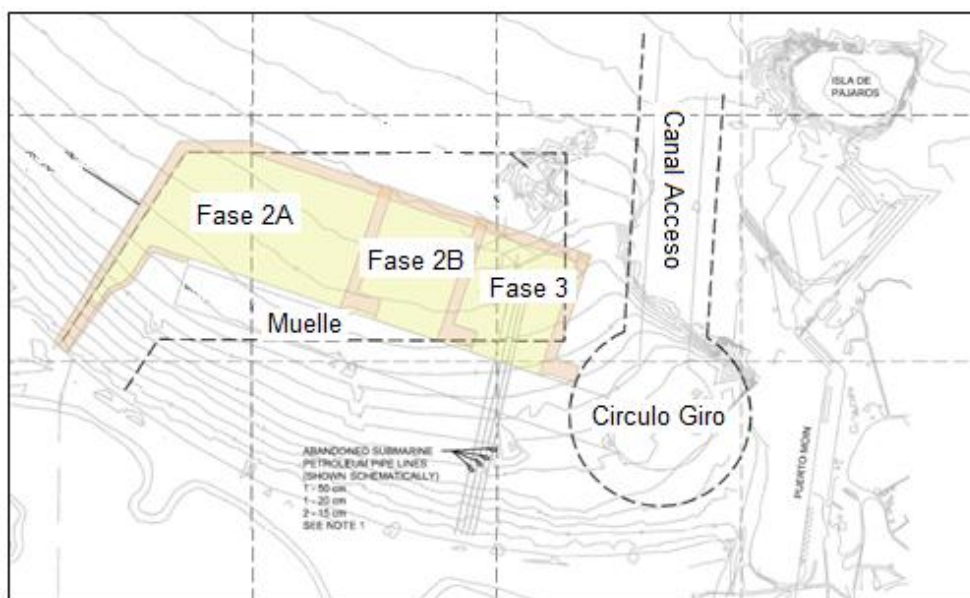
Vista en planta general del proyecto de reclamación. Fuente: Modificado de APM Terminals (2016)
